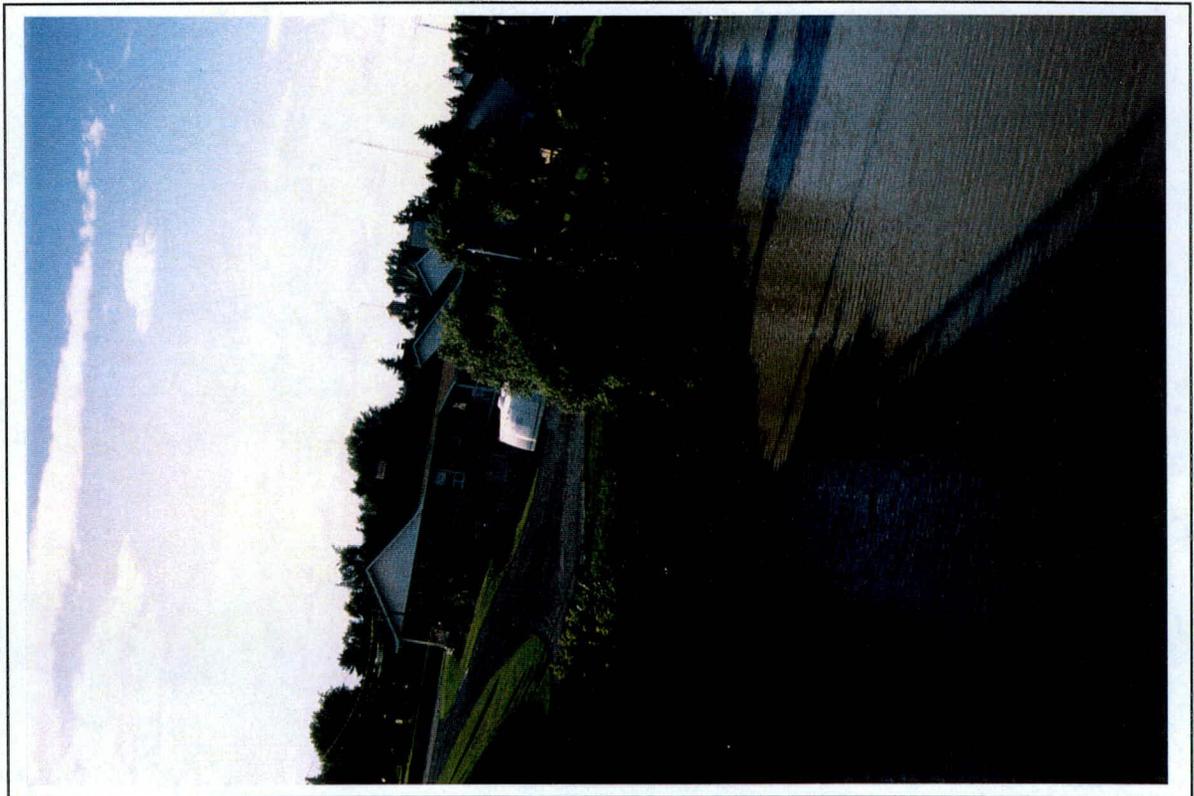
Projet 5372-9816, Route 235, secteur 2, portion est. (E)
